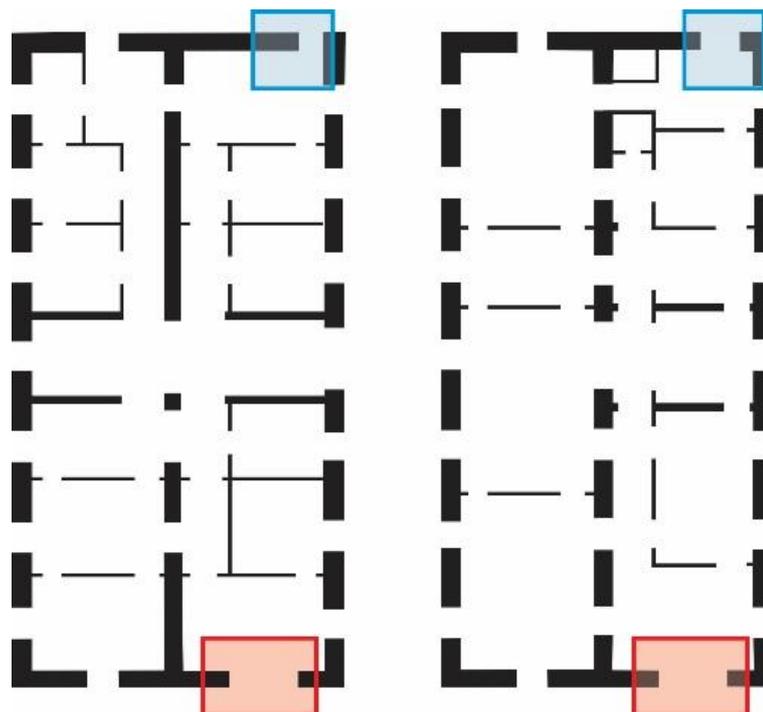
Planta baixa do 1º pavimento (à esquerda) e do 2º pavimento (à direita) do Bloco II do PSC em 1864. Destaque em vermelho para os vãos que conectam o Bloco I com o Bloco II e detalhe em azul para os vãos que conectam o Bloco II com o Bloco IV.
